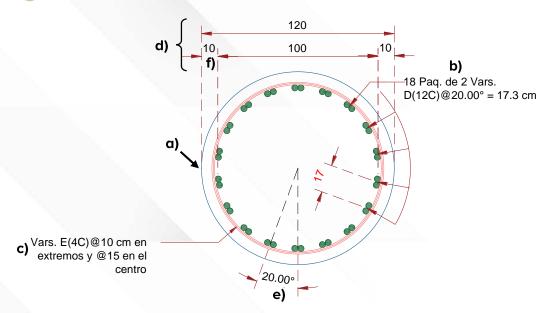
Ejemplo de elevación del refuerzo de pilotes de pila
